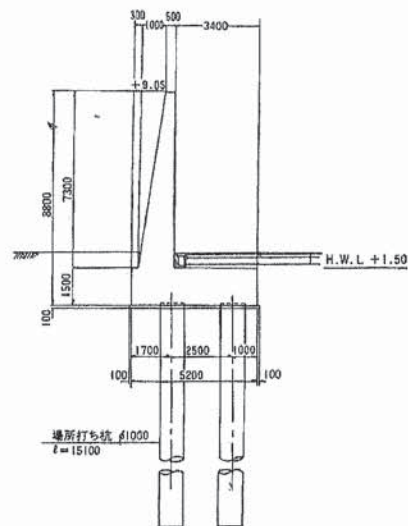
杭基礎を用いたL型式胸壁の例
